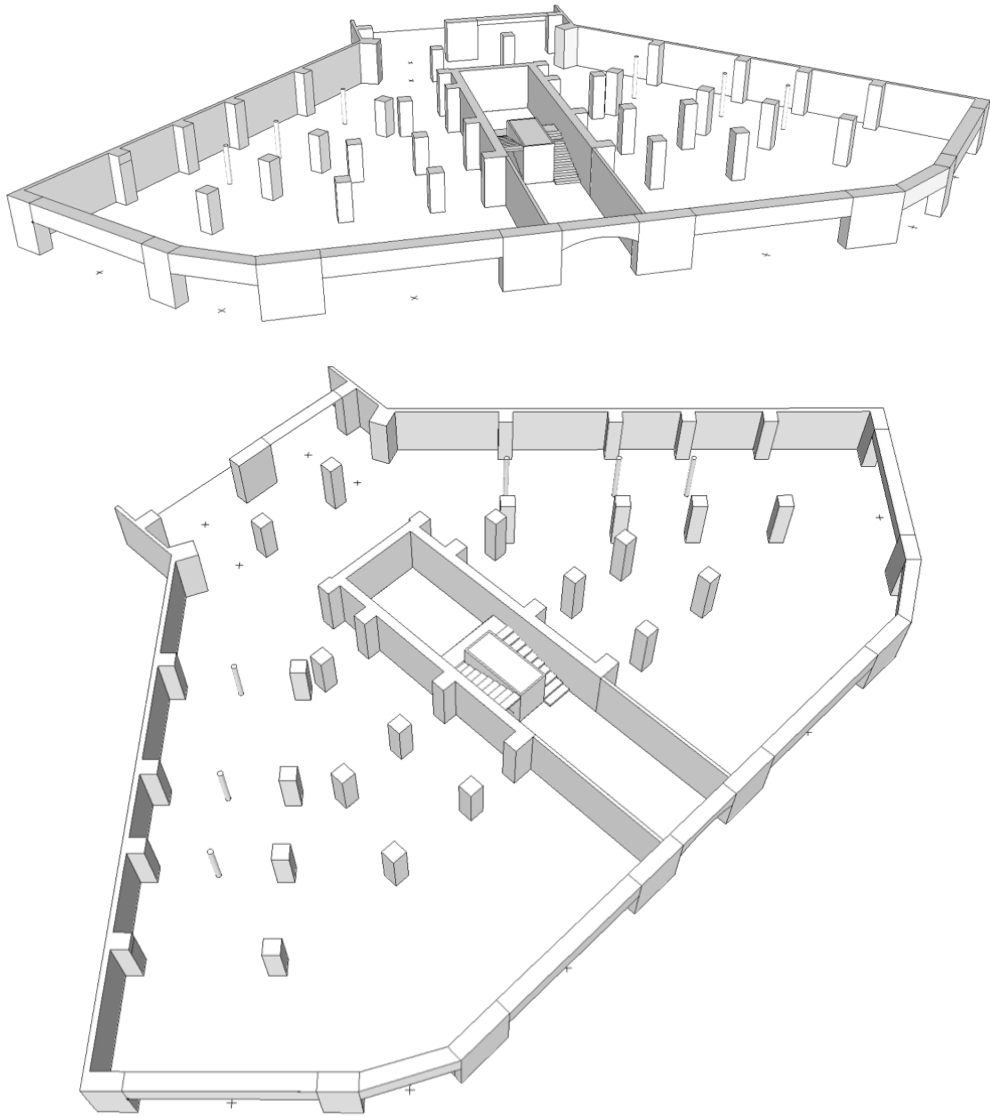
Vistas isométricas de PLANTA BAJA del edificio ED-04 (fuente: elaborado por el autor)
